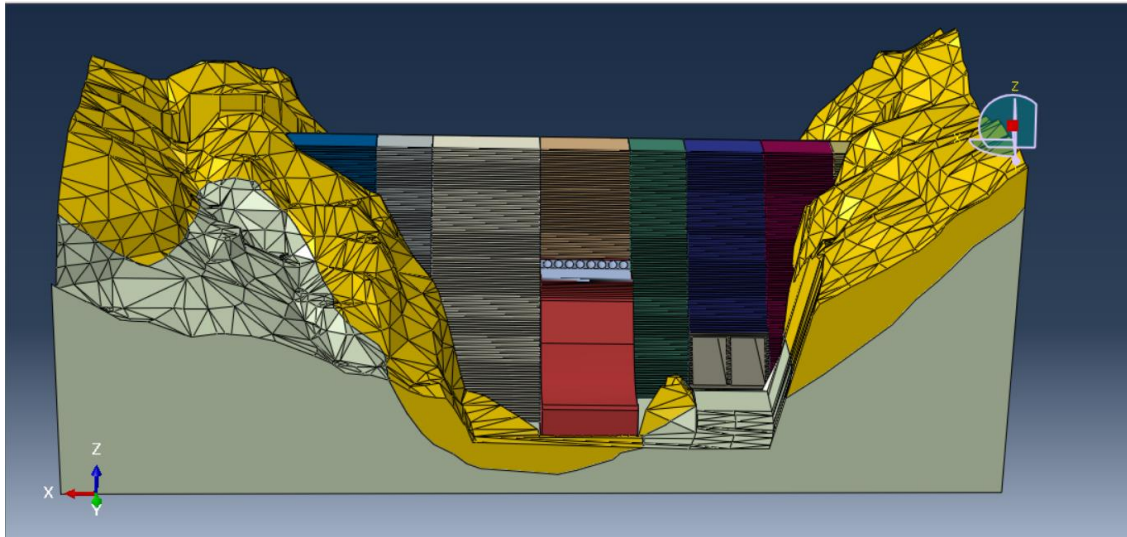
Geometría tridimensional de la cortina de la presa Pilares en la etapa 8 de construcción, en la elevación 220.00 msnm.
